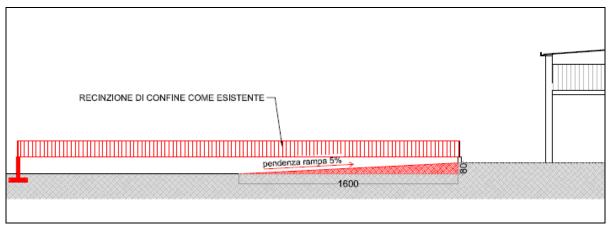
Sezione A-A della rampa in progetto: stracio dalla Tavola Unica di progetto.
